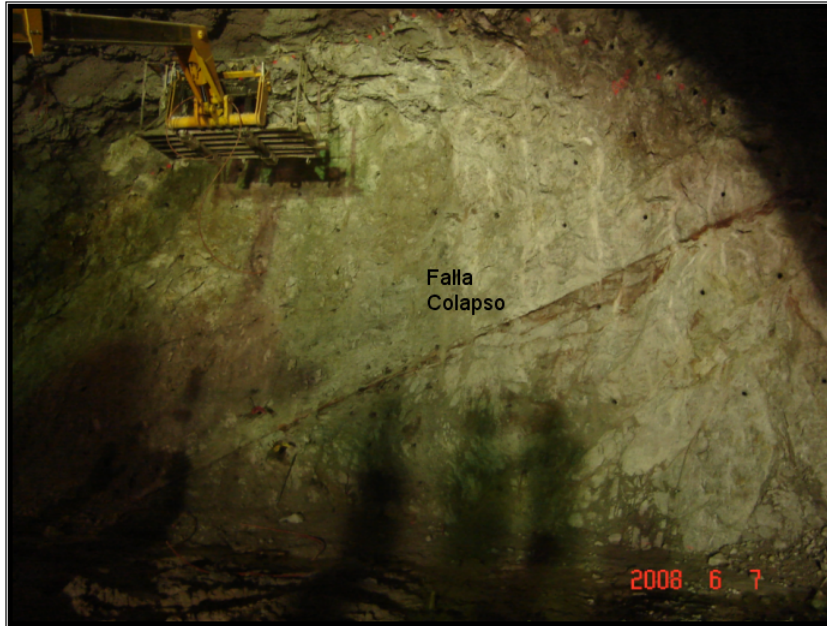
Falla Colapso en el tunen de desvío No. 1.
